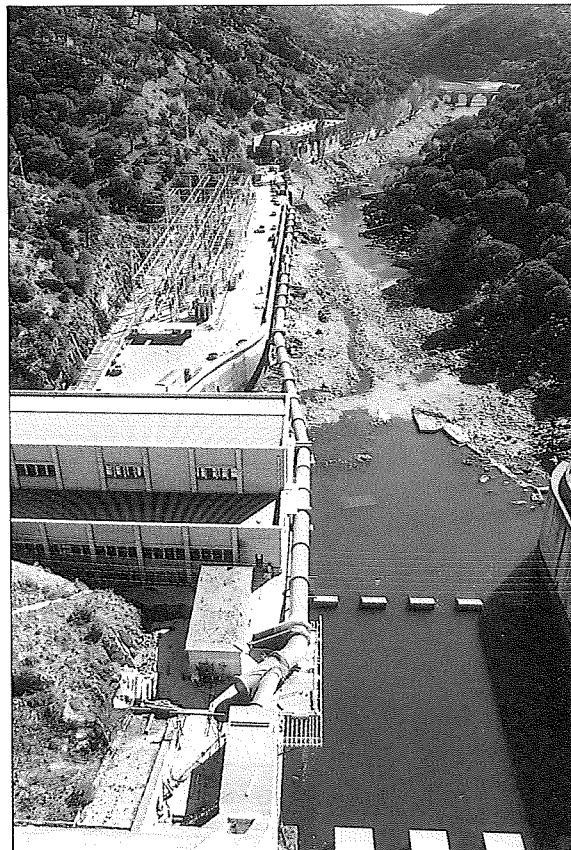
Detalle de toma del desagüe de fondo del Embalse de San Juan.
